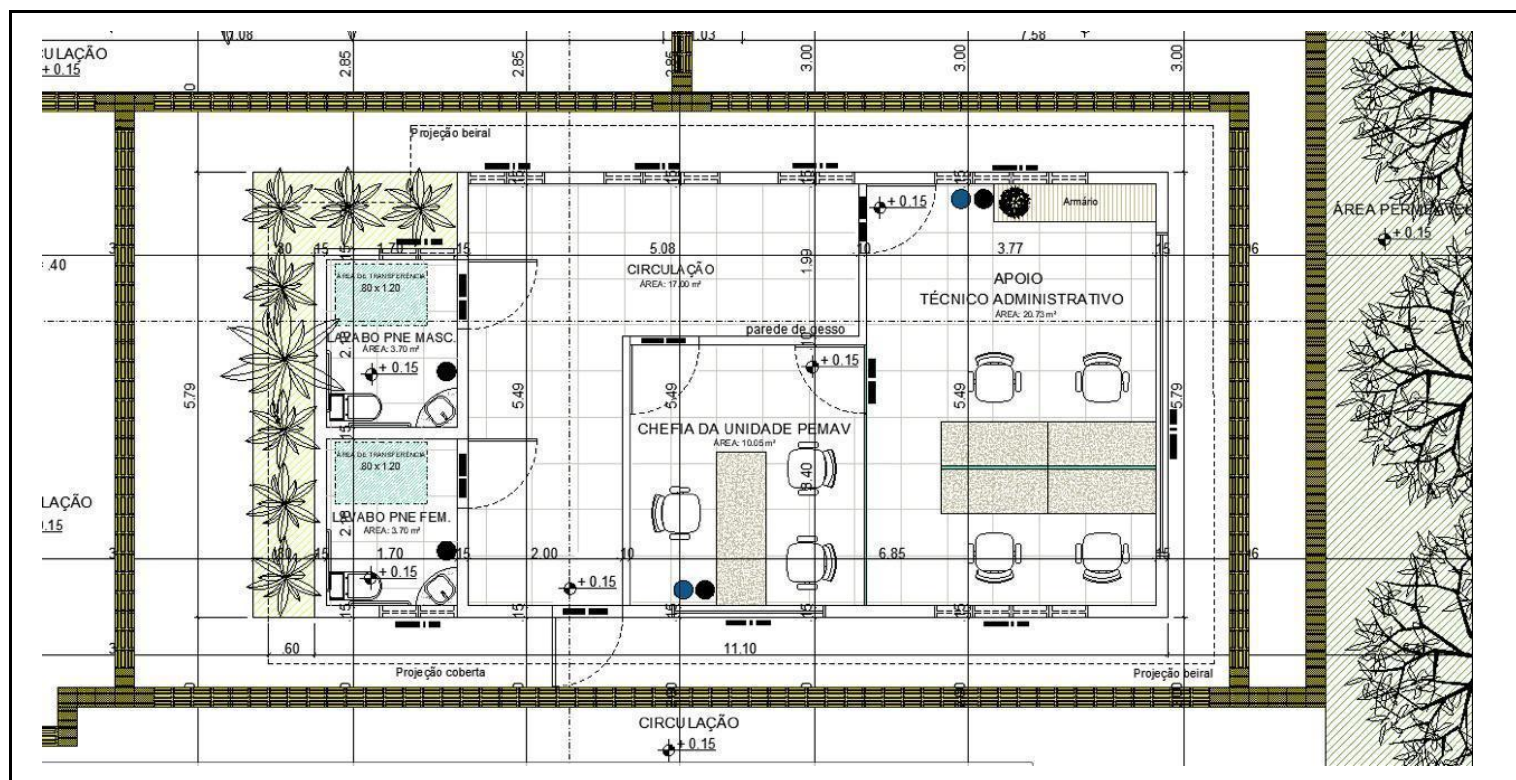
Planta baixa do projeto da sede do PEMAV.
